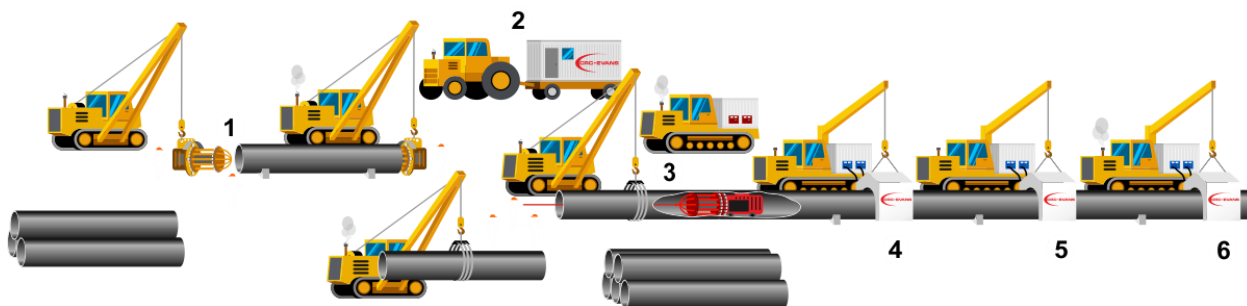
Схема сборки и сварки стыков магистрального газопровода
